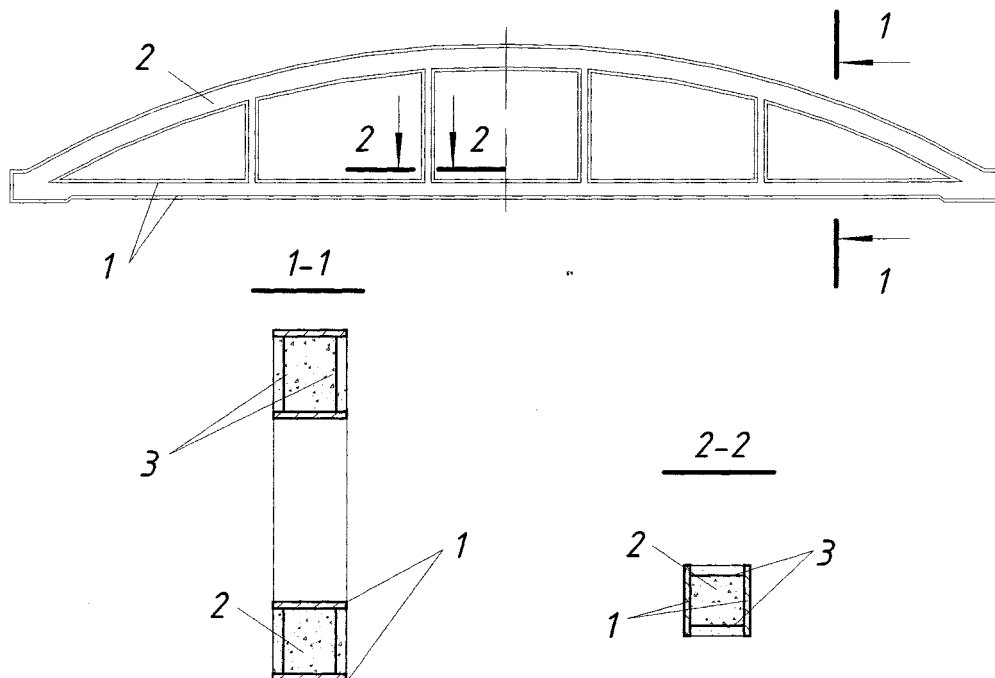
Залізобетонна арка із зовнішнім листовим армуванням
